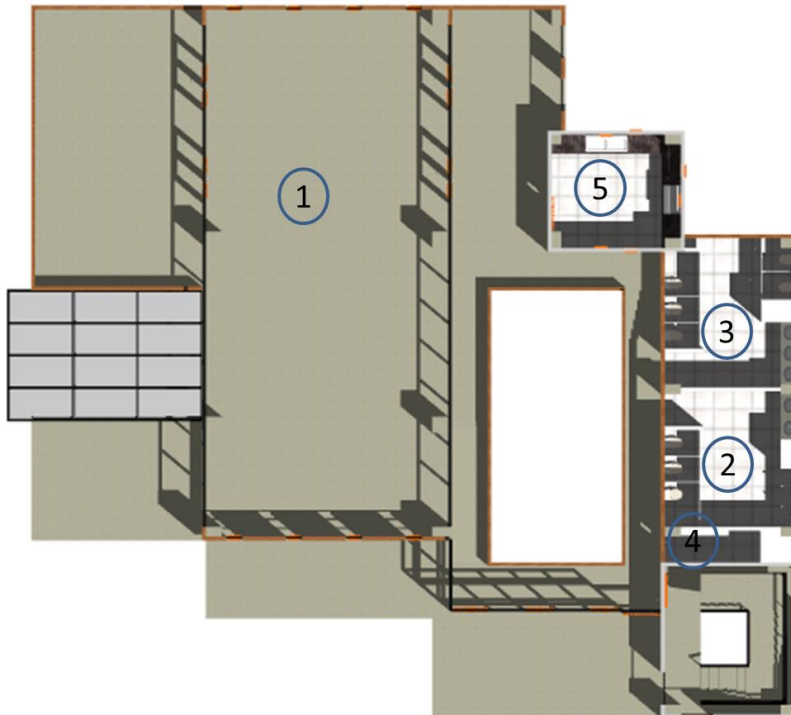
Distribución planta de primer piso salón comunal AJS-I
